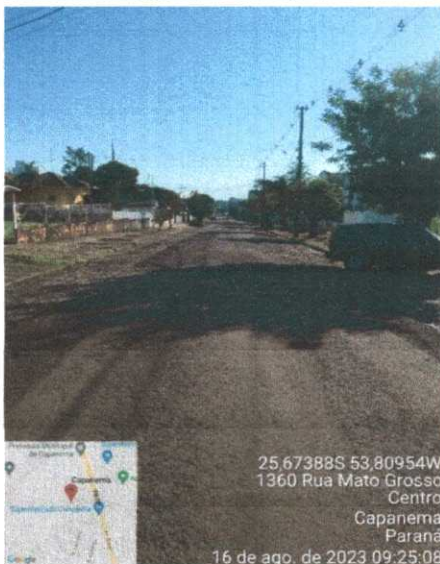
Fim do Trecho da Rua Padre Cirilo, cruzamento com a Rua Mato Grosso.
